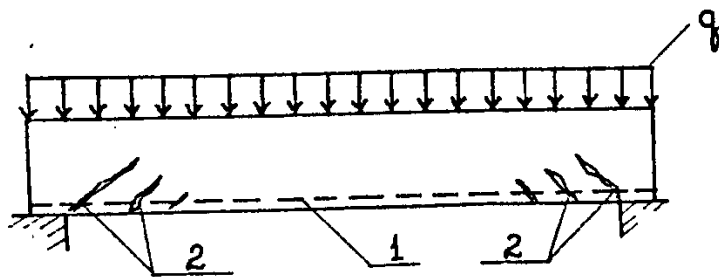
Залізобетонна балка, що має похилі: 1- згинальний залізобетонний елемент; 2- похилі тріщини.
